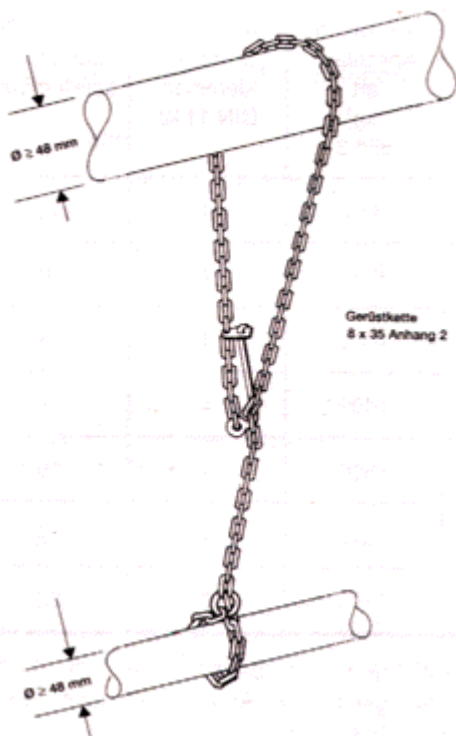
Geschnürte Anschlagart mit Gerüstkette
